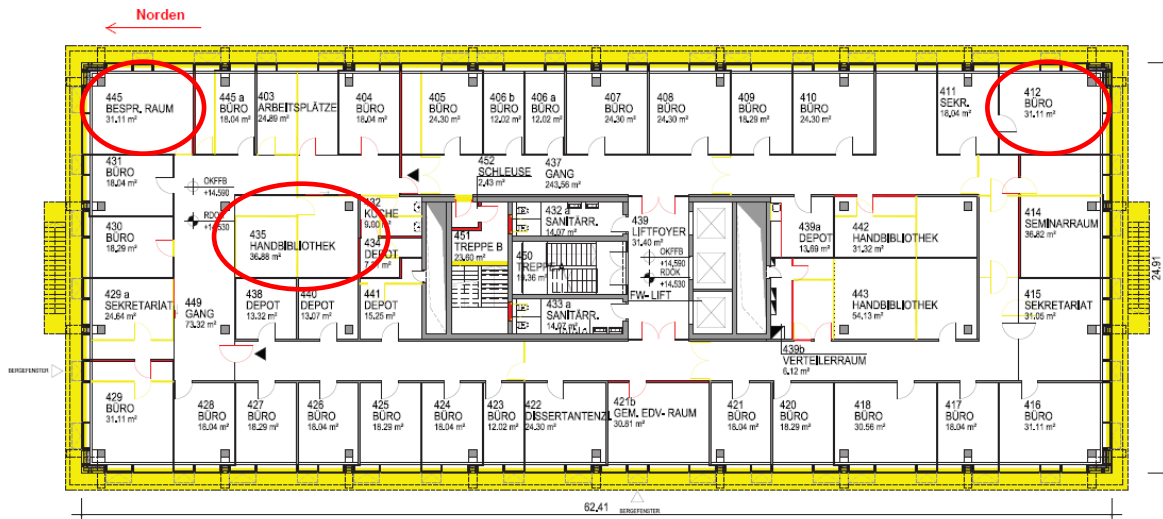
Grundriss 4.OG mit markierten Referenzräumen, Quelle: ATP Architekten
